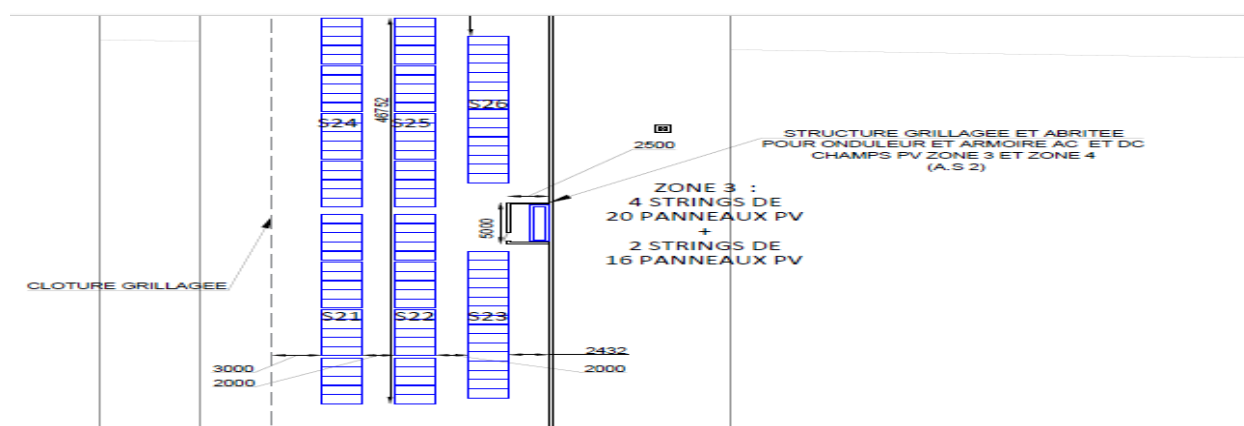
Plan d'implantation des panneaux photovoltaïques dans la zone 3
